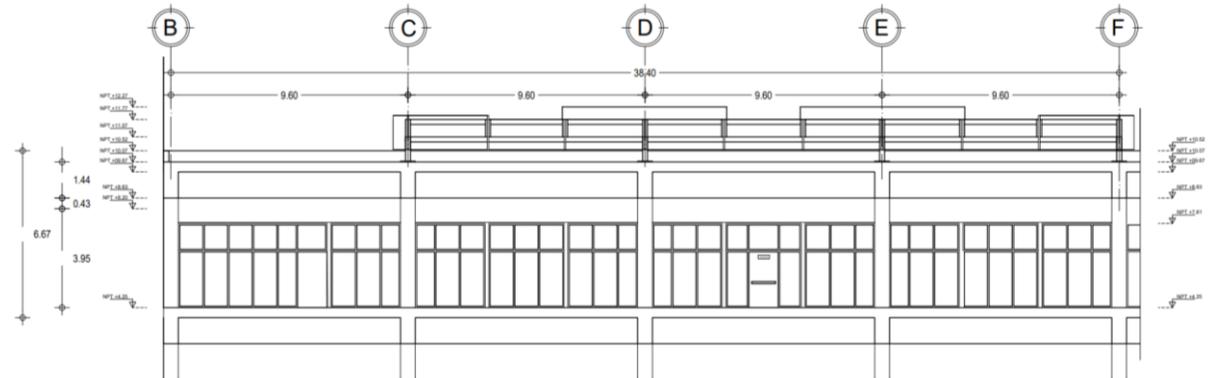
Fachada interior este, Primer nivel del MNA. Elaboración propia.
